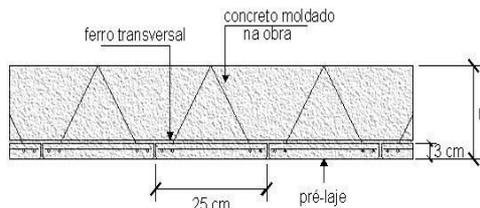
Pré-laje utilizada na construção da tremonha. Precast-concrete trussed panel used to build the hopper.
